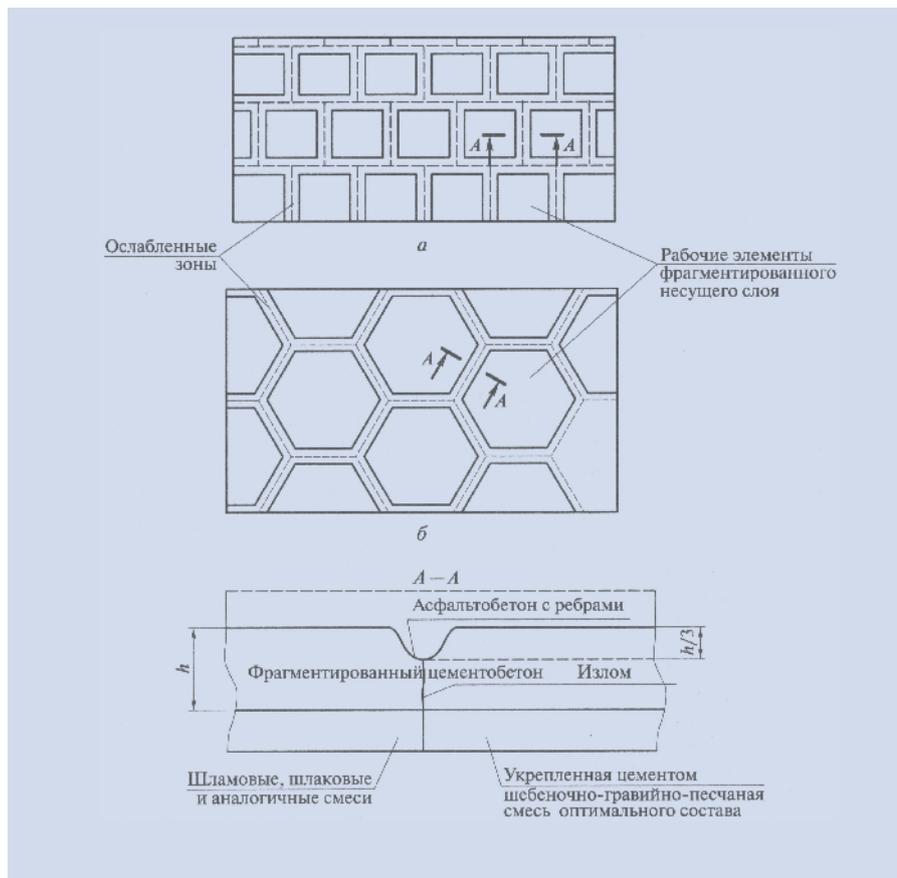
План и поперечный разрез фрагментированного несущего слоя дорожной одежды
